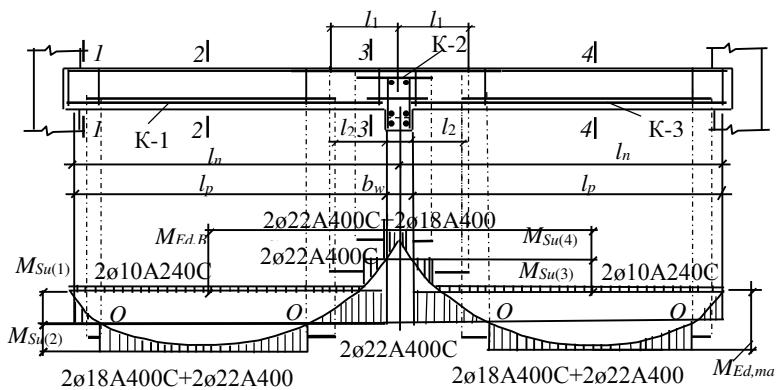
Схема армування звареними каркасами монолітної двох пролітної залізобетонної балки з побудовою епюри
